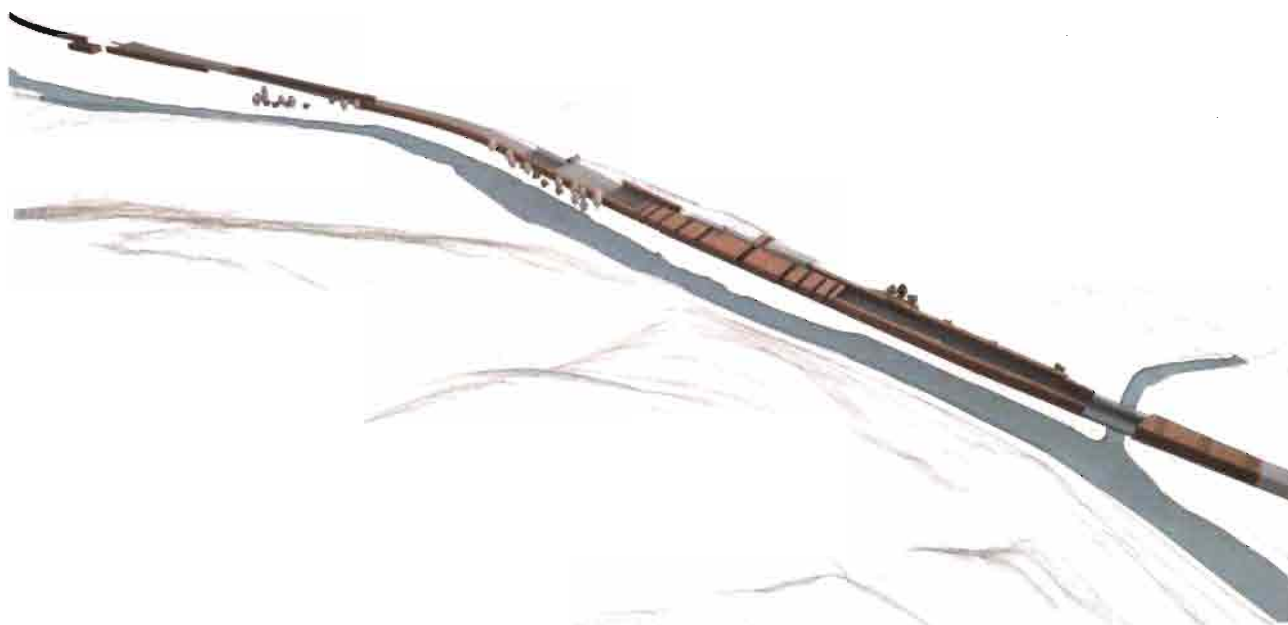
Interventi a Ponte Gardena: Vista assonometrica
